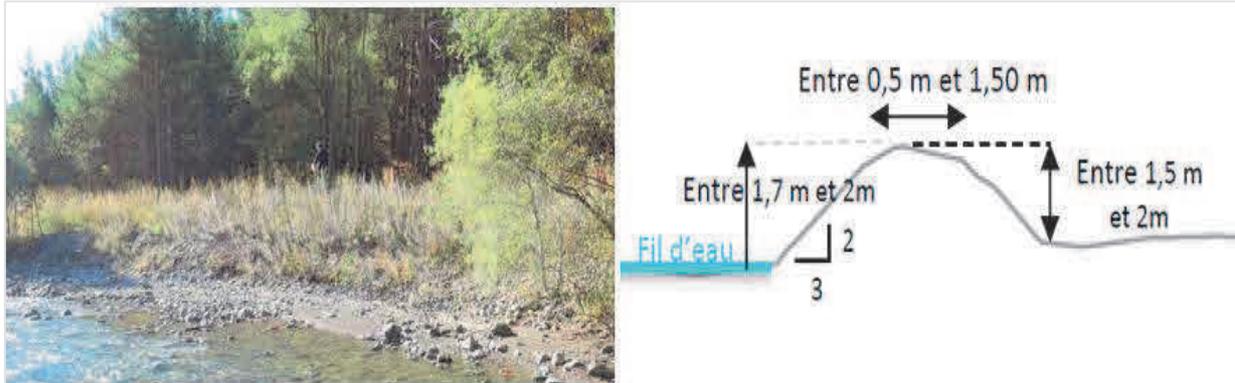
photographie (à g.) et coupe type (à d.) de l'ouvrage de protection – tronçon 4
